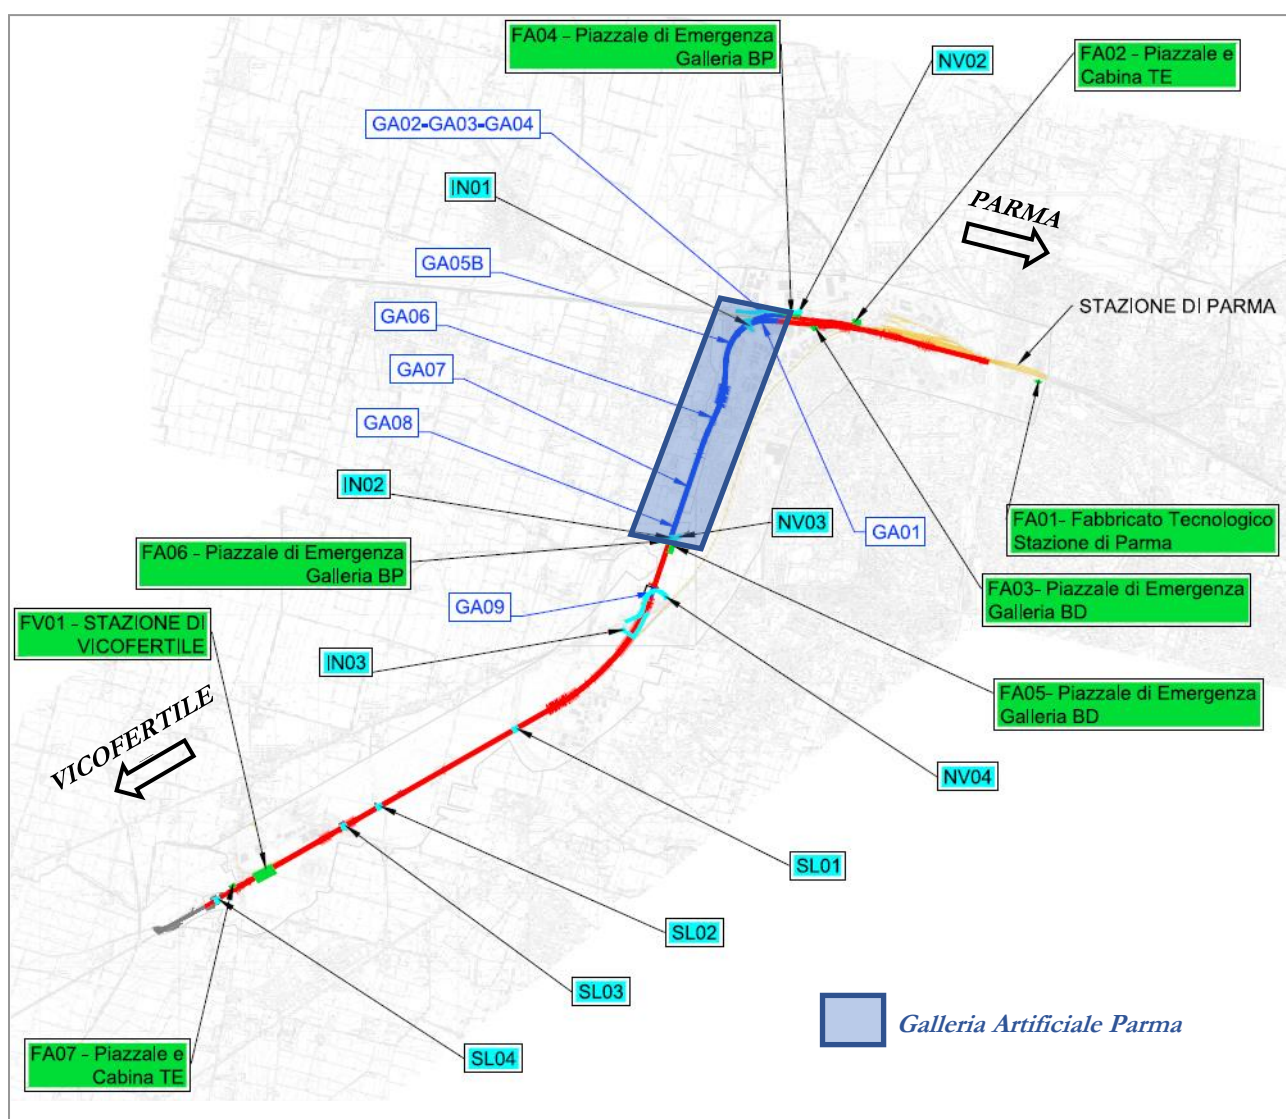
Stralcio da "Corografia" con individuazione dell'ubicazione planimetrica della Galleria Artificiale Parma
